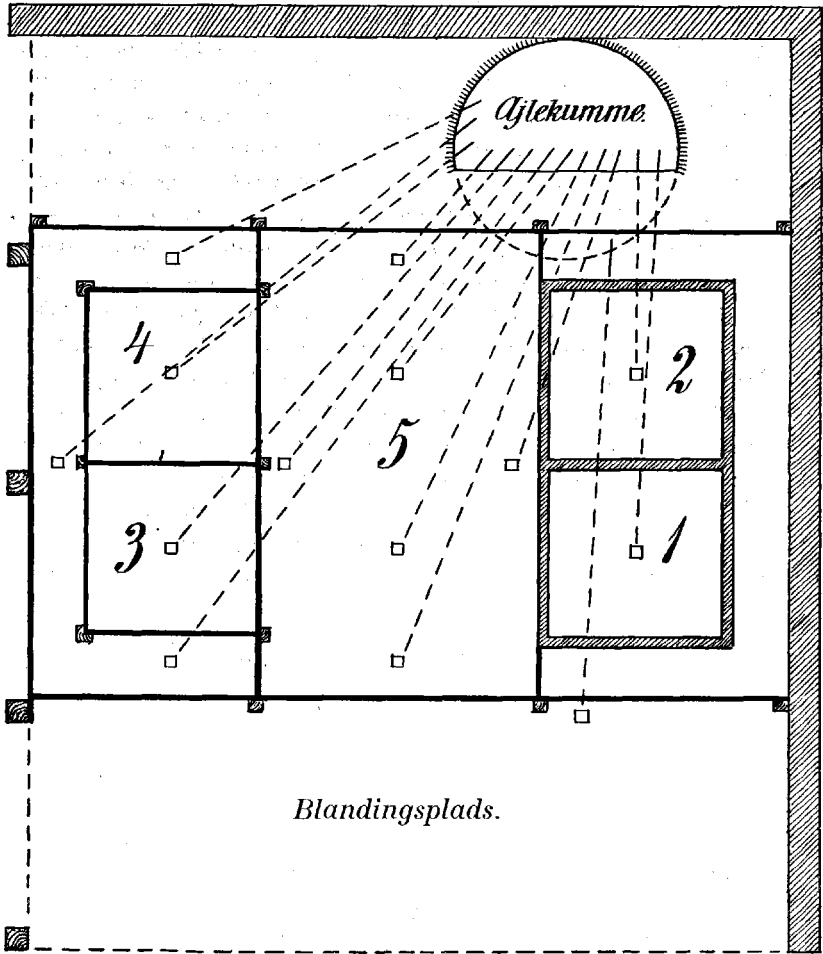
Grundriss af Møddinghus og Beholdere.
